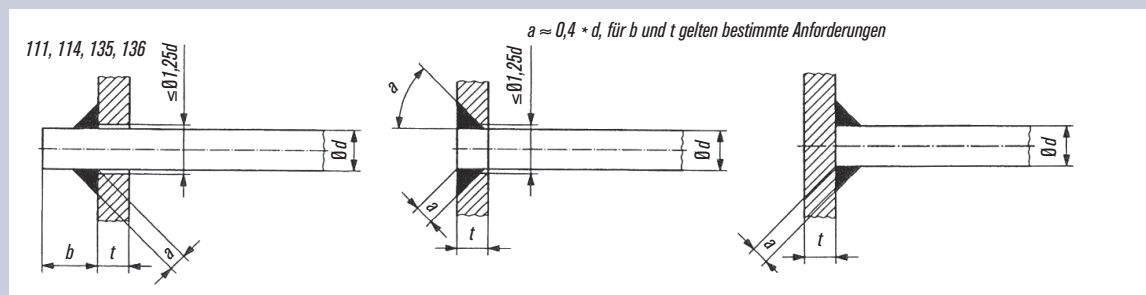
Tragende geschweißte Verbindungen an Betonstählen nach DIN EN ISO 17660-1, Ausgabe Dezember 2006, [9]
